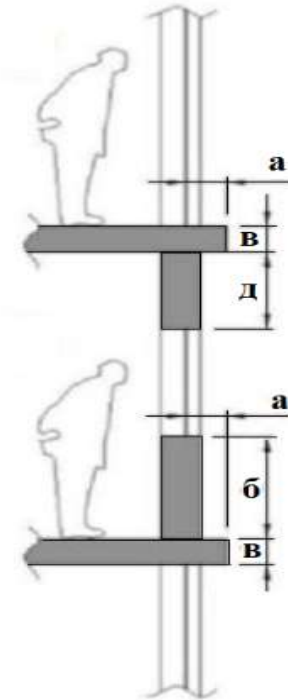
Приклад будівельної конструкції висотної громадської будівлі, яка зменшує площу світлового прорізу у фасаді висотної громадської будівлі для обмеження можливої теплопередачі від пожежі, де
